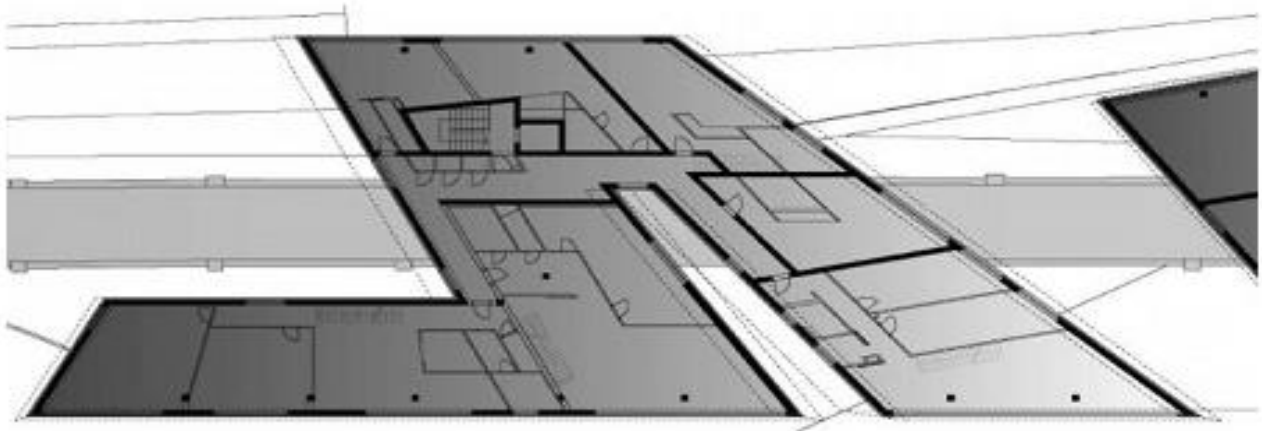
Vivienda Social plan de oficinas (<https://www.zaha-hadid.com> /imagen intervenida por el autor).
